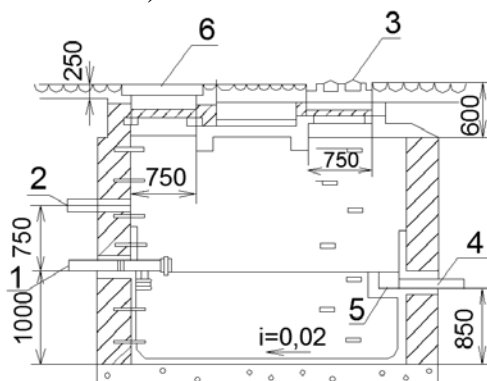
Грязеотстойник: 1 - подающая труба; 2 - труба вентиляционной вытяжки; 3 - крышка чугунная; 5 - железобетонная плита; 4 - выпускная труба; 5 - переливной железобетонный лоток, 6 - люк.
